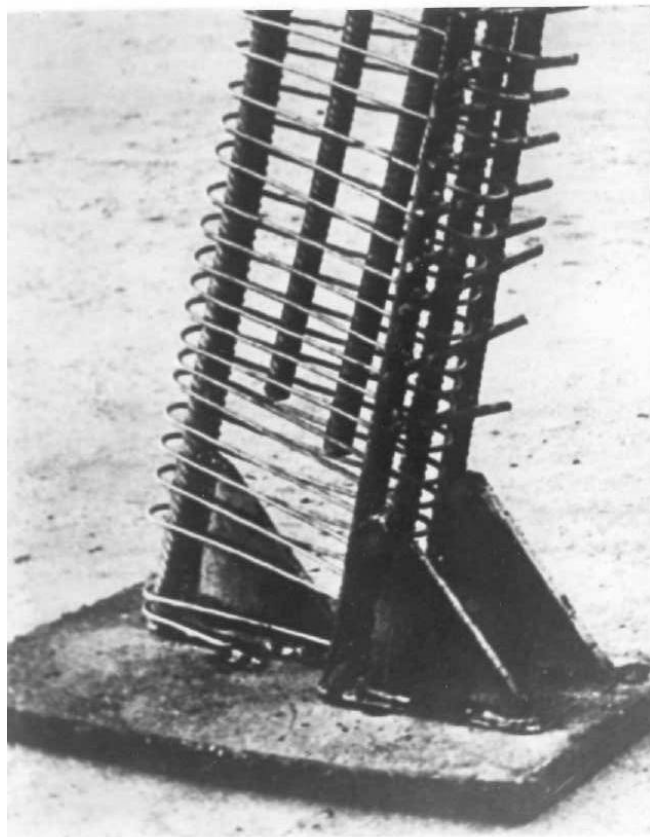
Армвання дослідного зразку конкового вузла ригеля піврами
